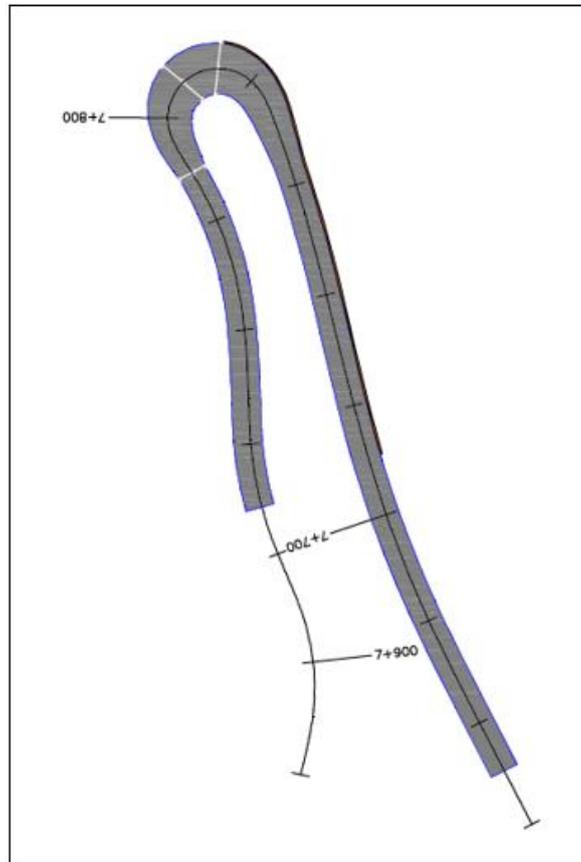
Planta del murete de hormigón armado entre el PK 7+700 y el PK 7+780.
